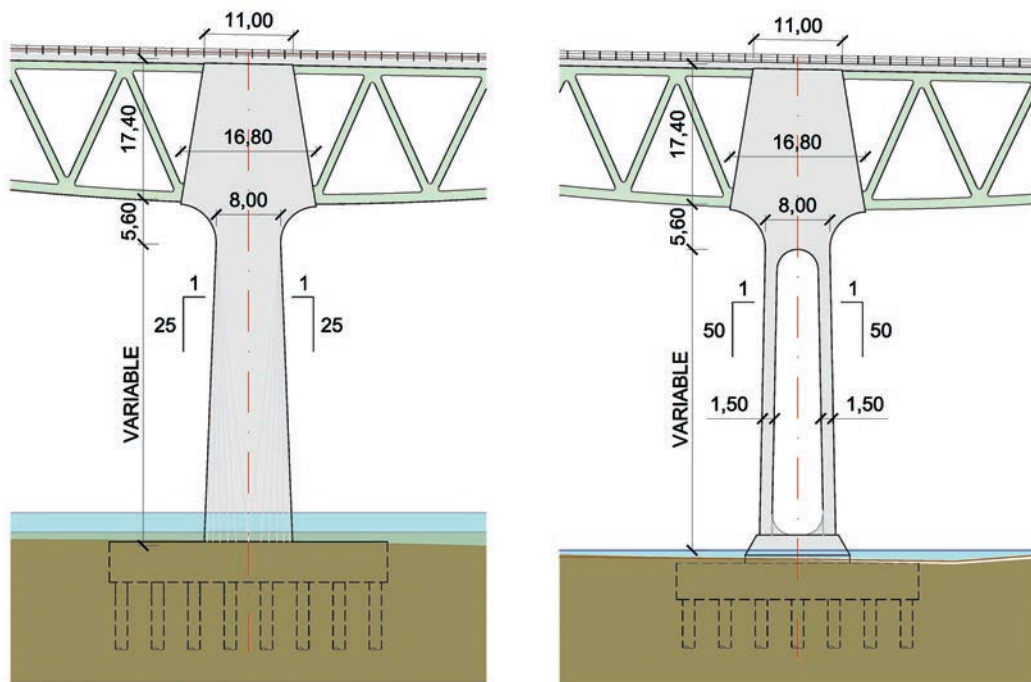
y 28b. Vista de las pilas centrales (P-6 y P-7) y laterales (P-5 y P-8)
